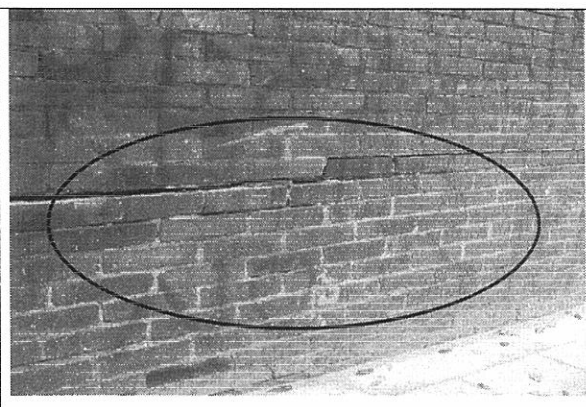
Muro sobre la carrera 13, fractura en la zona central
